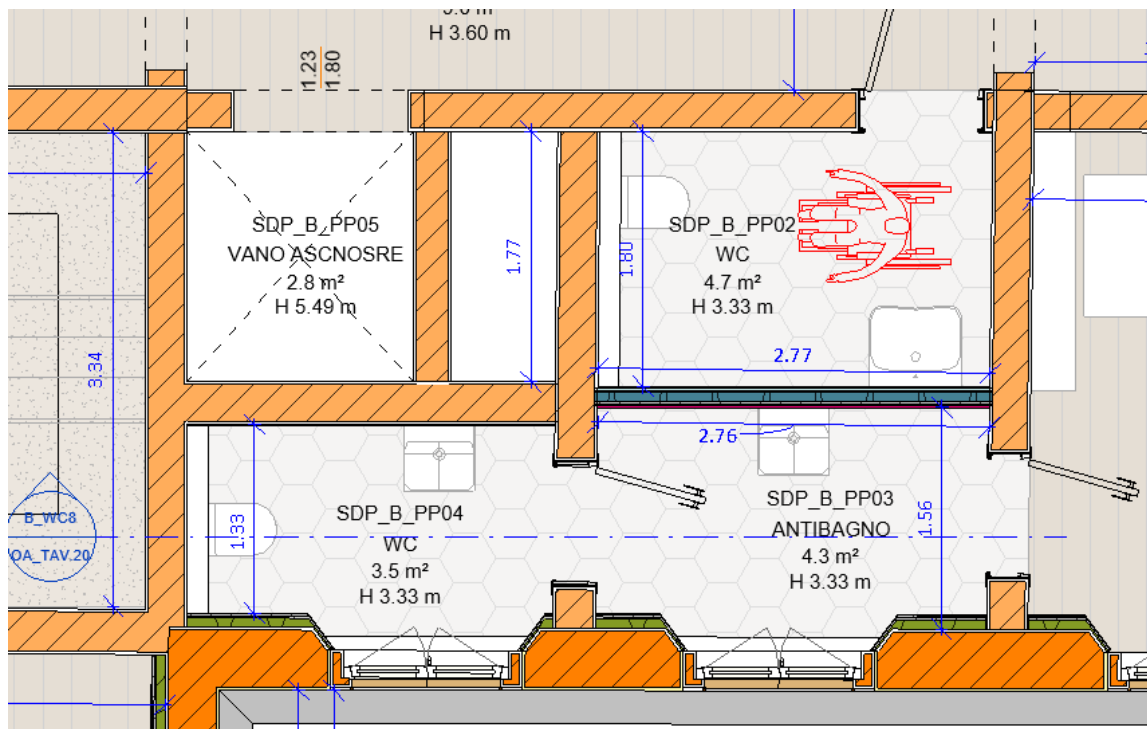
Estratto tavola di progetto – Edificio B pianta piano primo.
